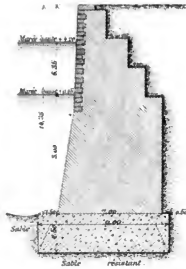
(Ech^{de} 0/5 p m) Elevation principale
